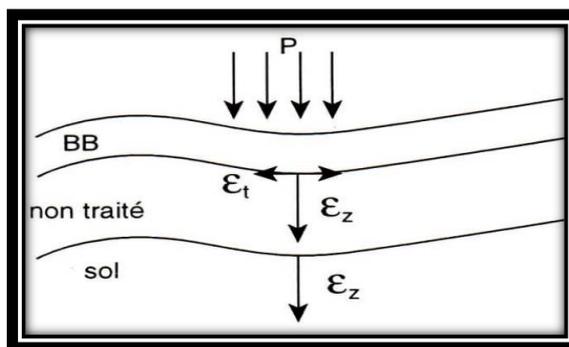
Schémas de fonctionnement d'une structure de chaussée(26)
